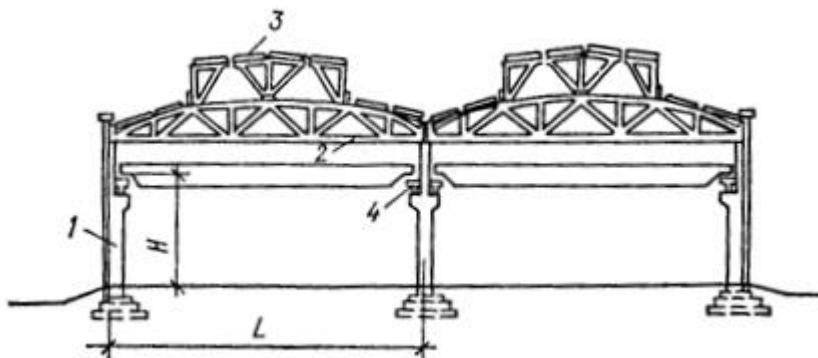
Схема поперечної рами каркасу одноповерхової промислової будівлі з мостовими кранами:
